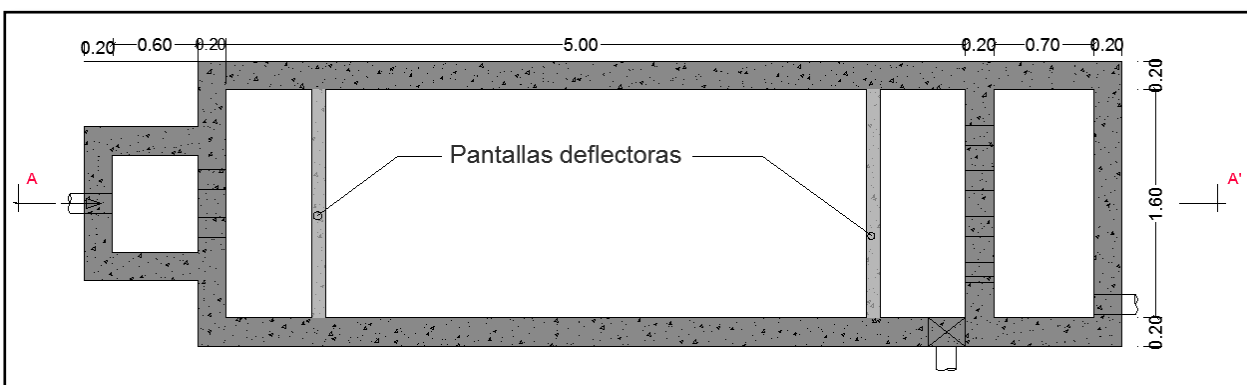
Vista en planta del desarenador existente. Fuente: Autores del proyecto.
